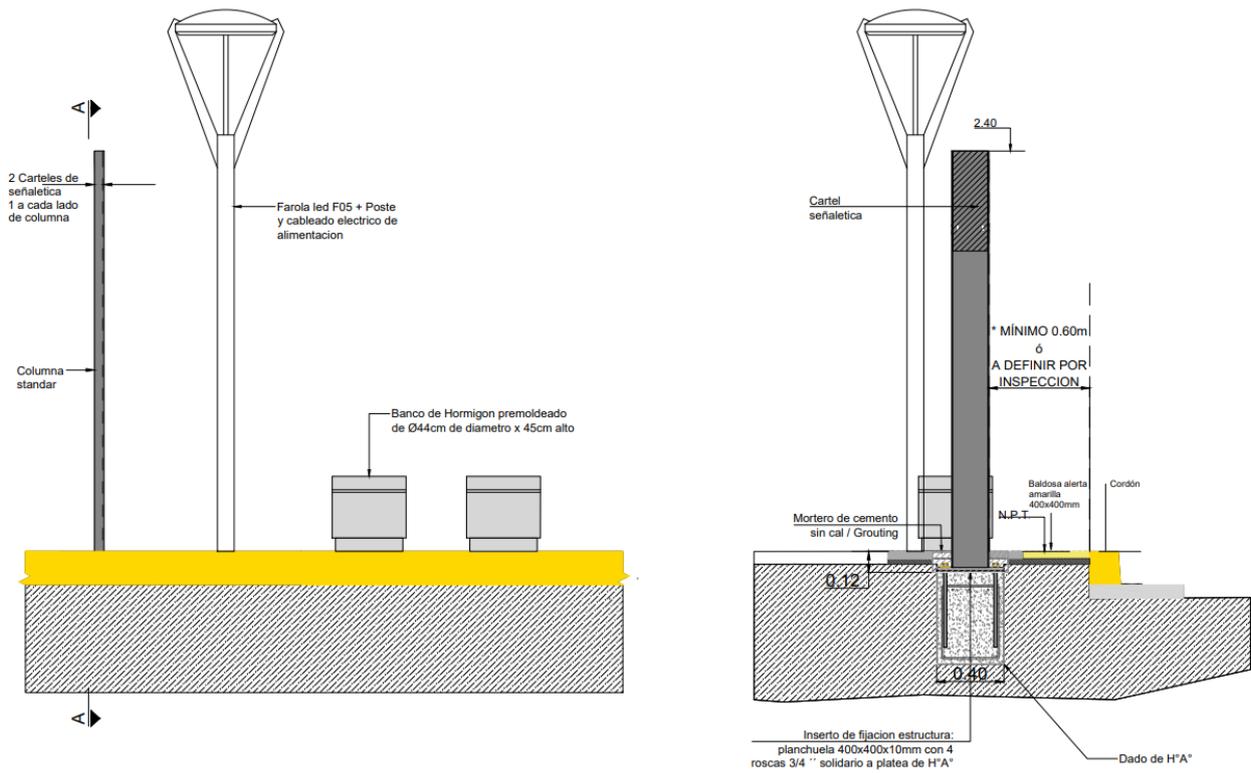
E. – Vista y Corte del Refugio Tipo tótem utilizado por el Ministerio de Obras Públicas de la Nación
